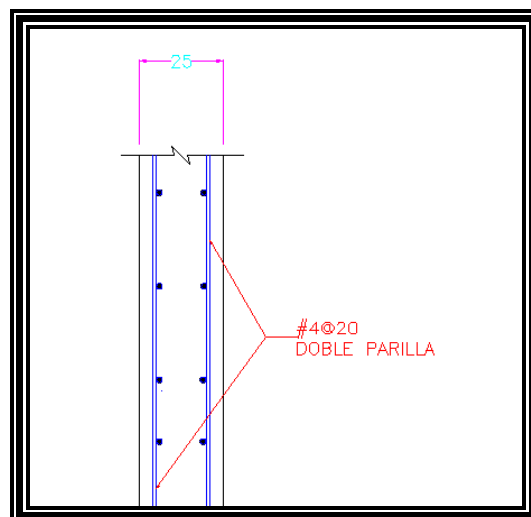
Acomodo de acero de refuerzo en 2 parrillas en muro de tanque
